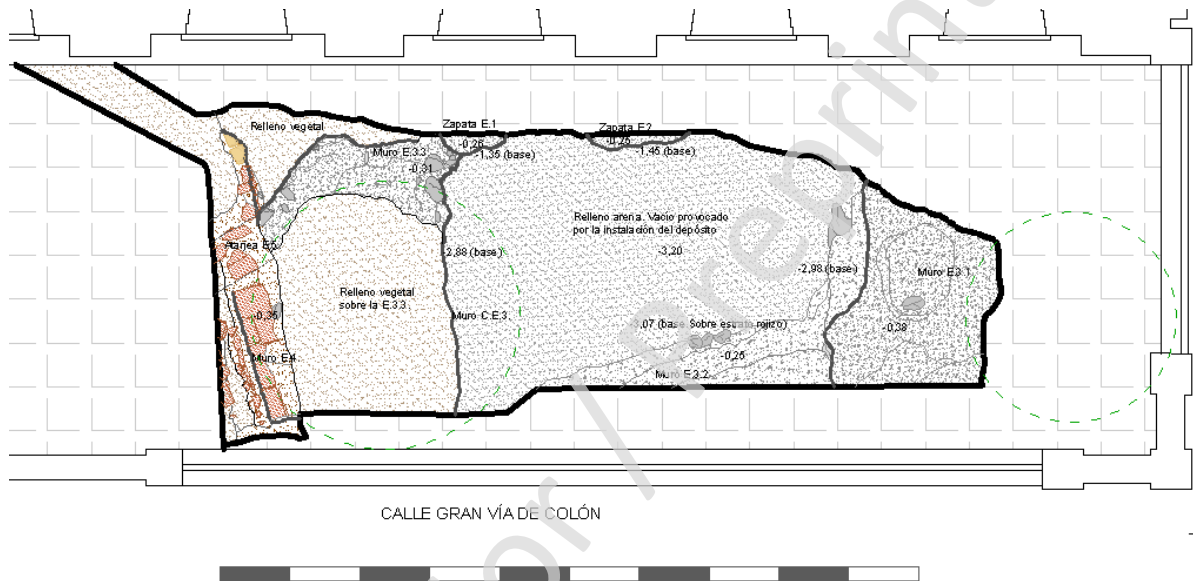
Planta general de la excavación. Escala gráfica 10m
